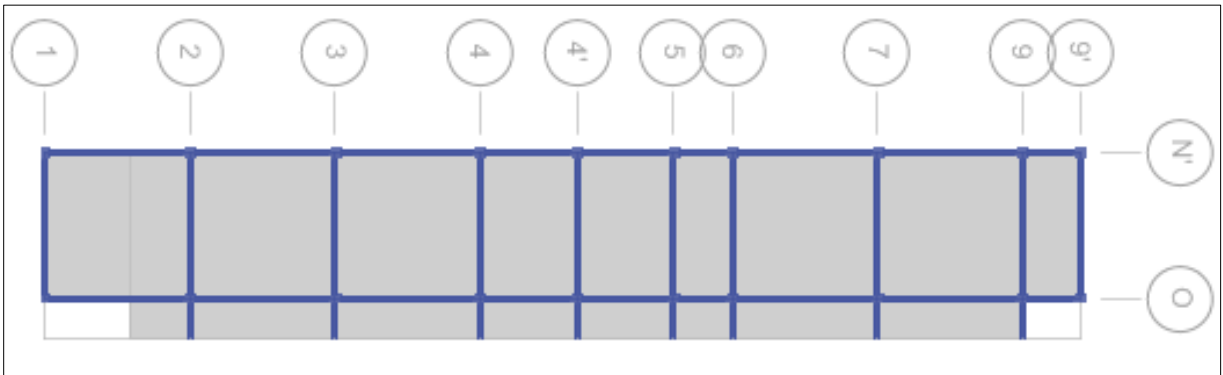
Planta estructural N+6.21 Estructura 4.32 Torre Oriental
